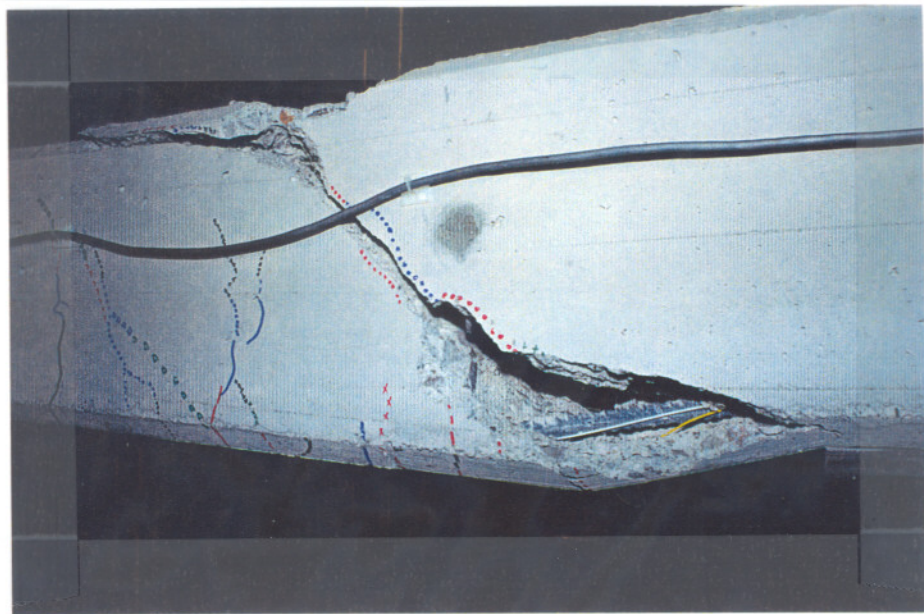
Detalle de la rotura de la viga C24. En las vigas "C" llegó a romper el cerco que atravesaba la grieta de cortante.
